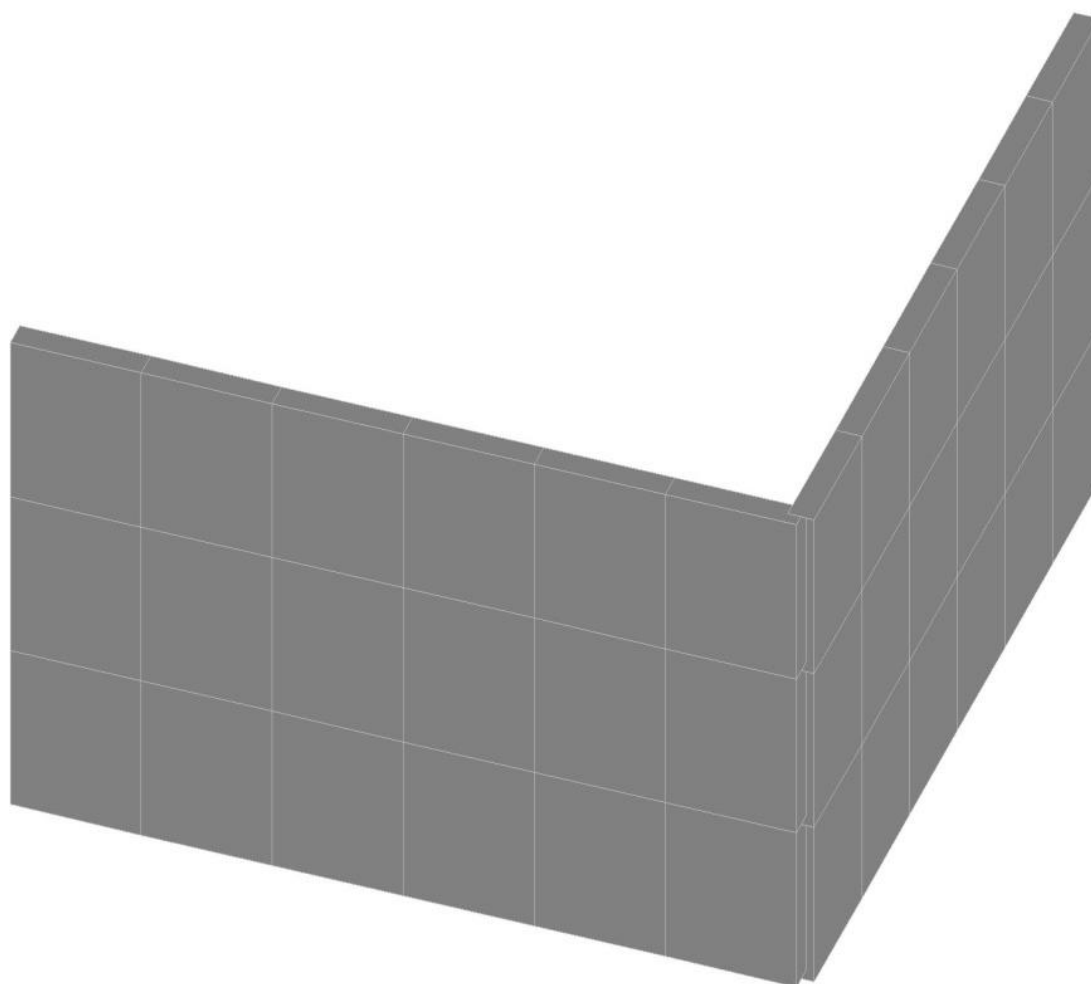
Расчетная схема фрагмент стены из газобетонных блоков жилого дома (разработано автором)
